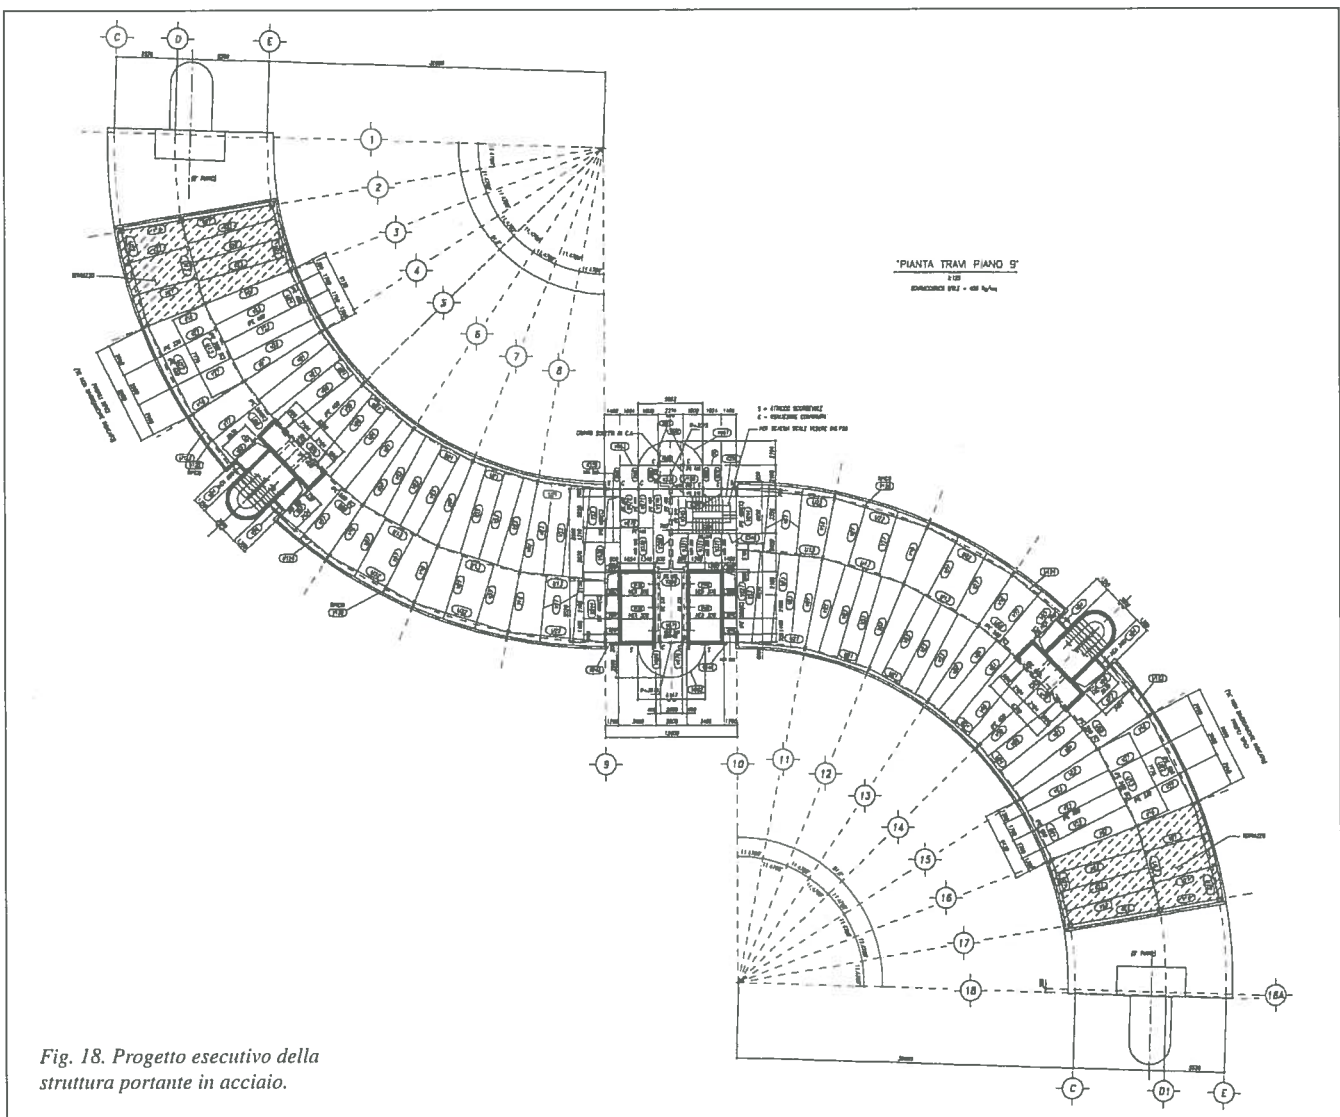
Progetto esecutivo della struttura portante in acciaio.
